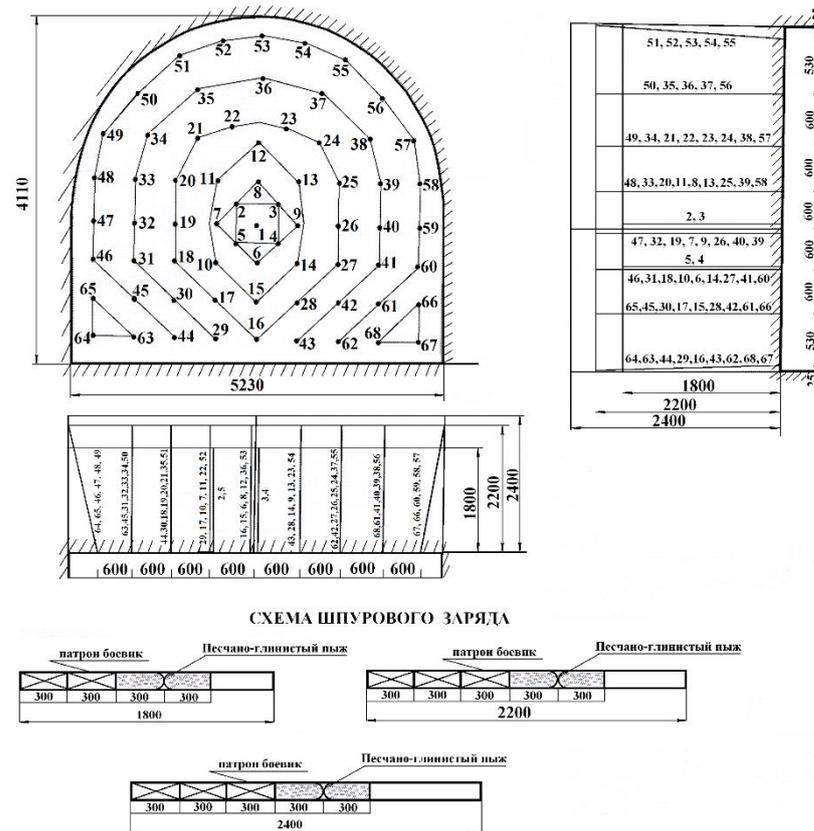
Паспорт буровзрывных работ при вскрытии выбросоопасного угольного пласта
